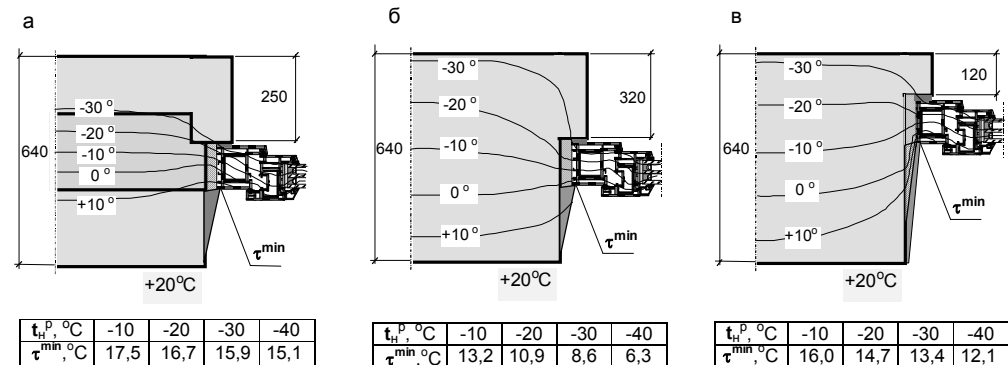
Распределение температур по сечению кирпичной стены толщиной 640 мм: а – при наличии в толще стены слоя эффективного утеплителя; б – при смещении оконной коробки к центру стены; в – при утеплении оконных откосов со стороны помещения
